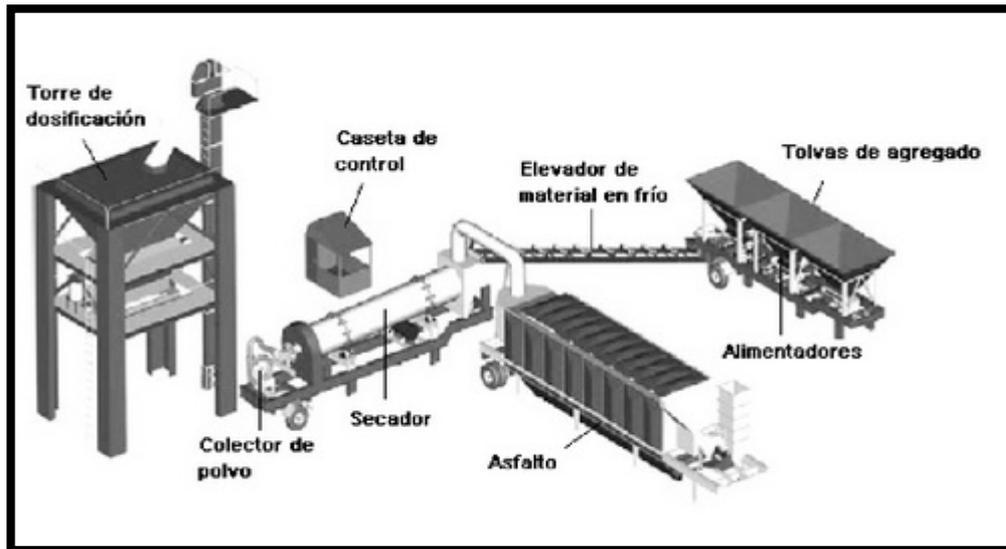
ejemplo de una planta de mezclas en frío (Fuente: maquinaria y construcción.blogspot).
